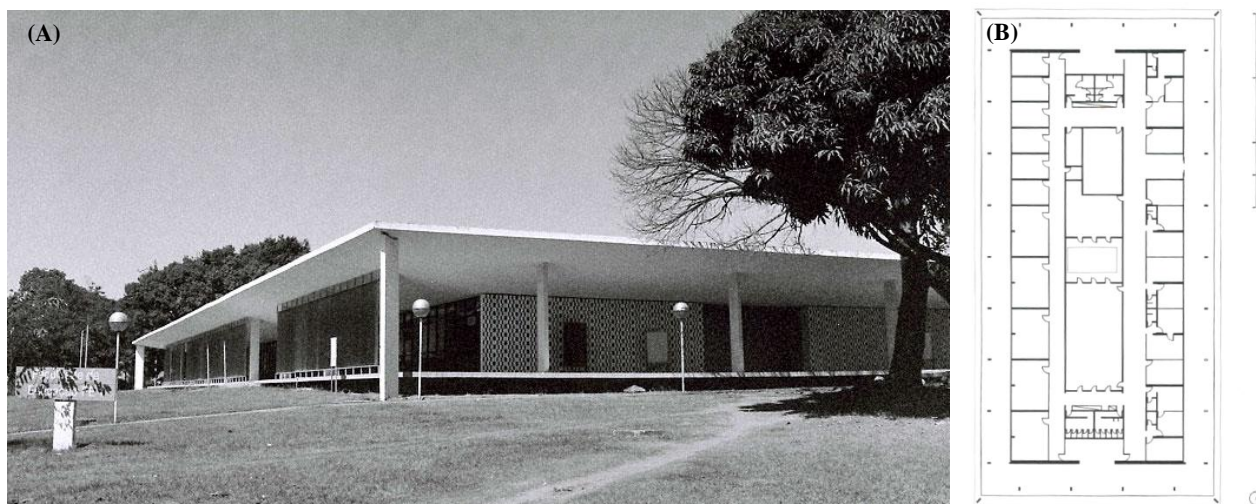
FE 1 - (A) Vista e (B) planta baixa.
